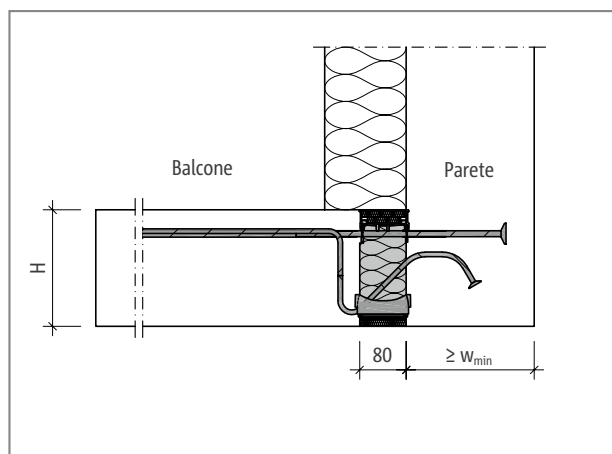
Schöck Isokorb® T tipo KL-U: raccordo al piede della parete con isolamento esterno
